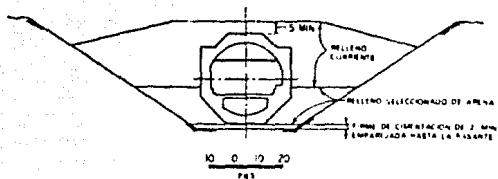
LOS TUNELES DEL TIPO TUBO HINCADO SE COLOCAN EN UNA ZANJA QUE LUEGO SE RELLEA.
